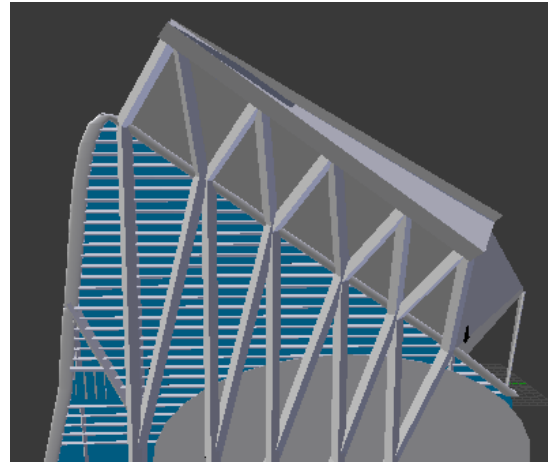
Modelado en Blender de la fachada lateral, vista frontal
